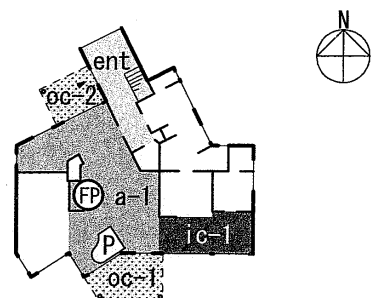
No.26:3 Grundrisse fur Wohnh.
